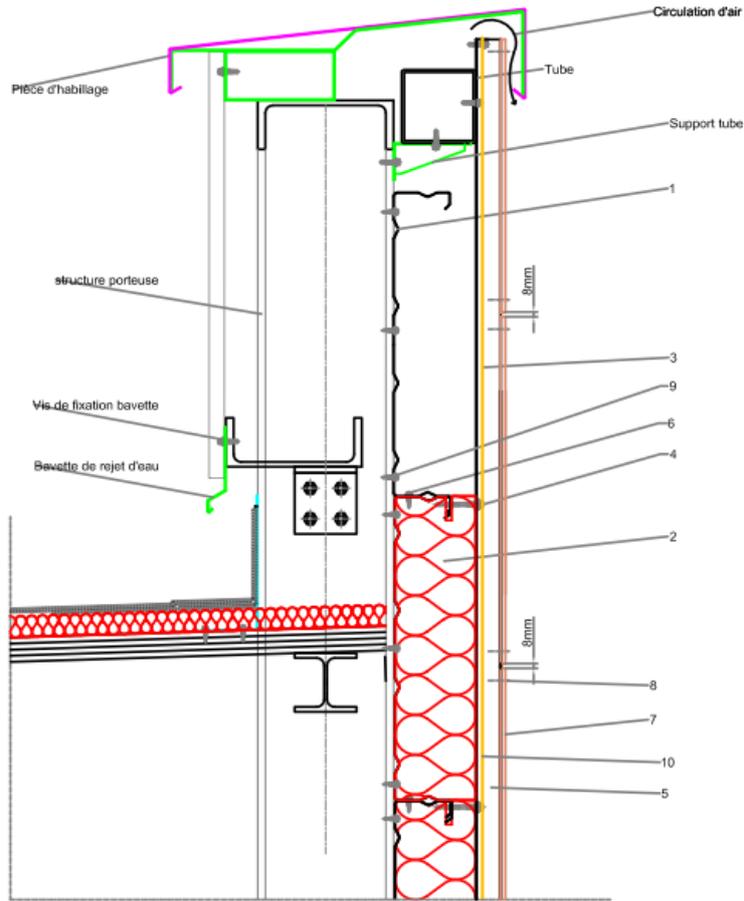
er – Arrêt sur acrotère – Coupe verticale
